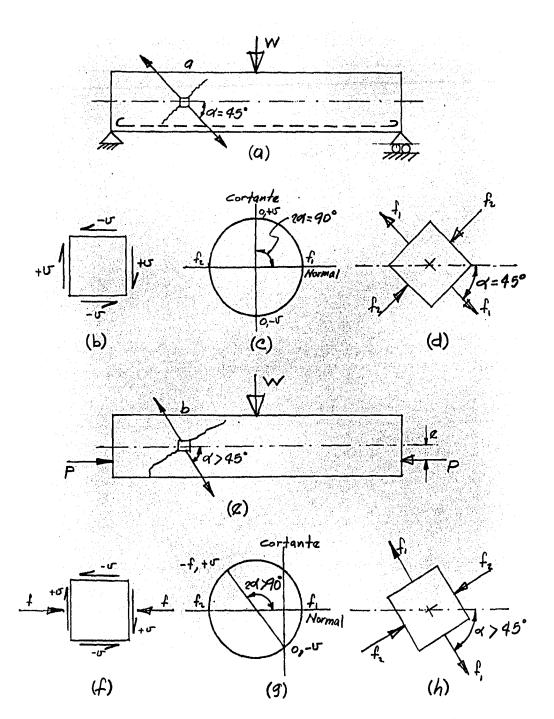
Efecto del presfuerzo longitudinal en la tensión diagonal y en el agrietamiento.
